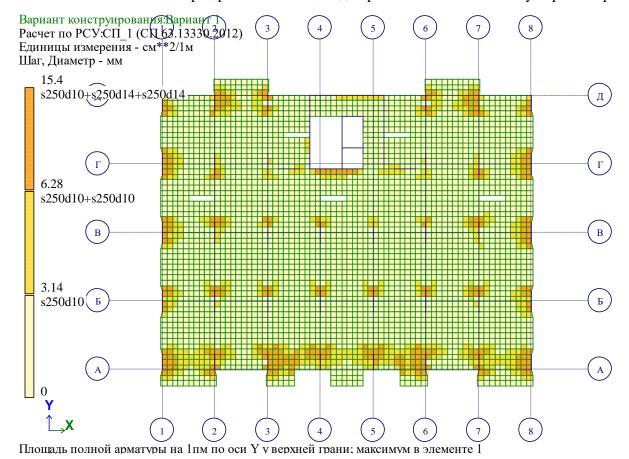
Расчетное армирование плиты над первым этажом по оси У у верхней грани.
